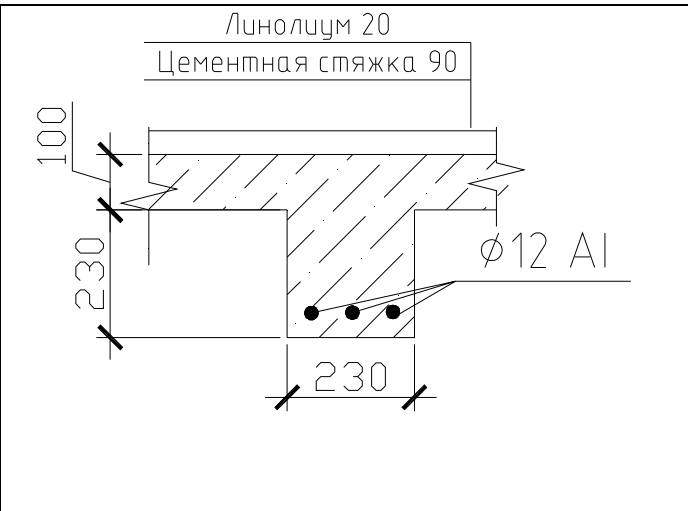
Второстепенная балка ж/б перекрытия над четвертым этажом в осях «8-9/А-Б, В-Г»
